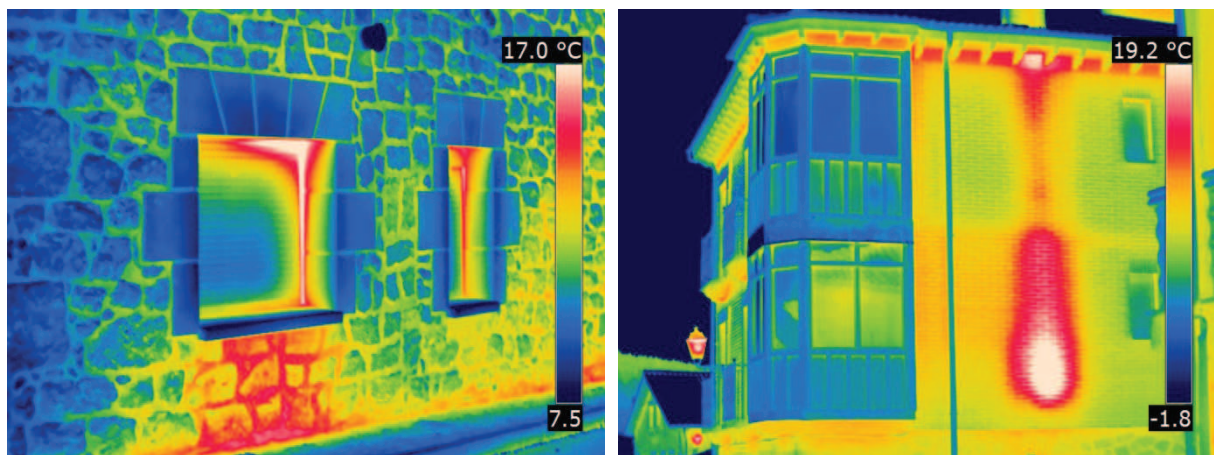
Defectos de aislamiento en fachada
